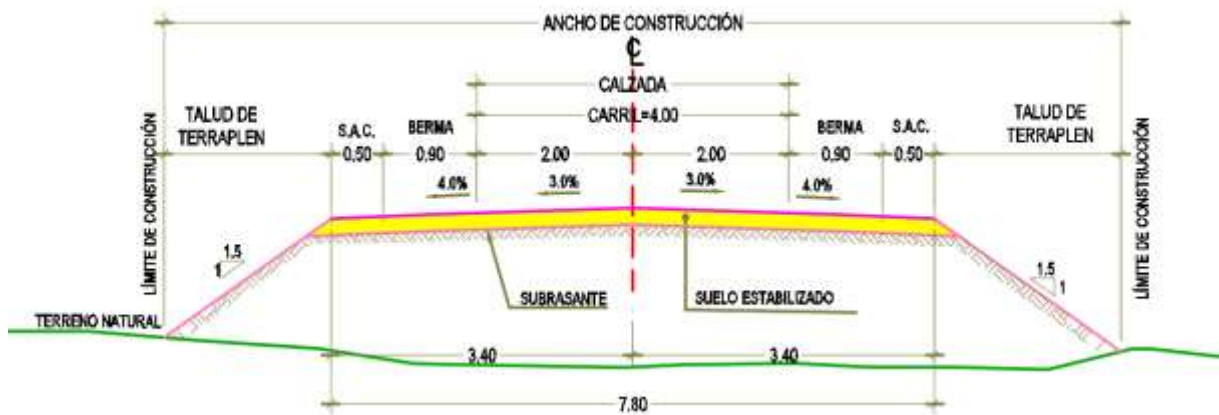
Sección típica en relleno. Fuente: Planos Secciones Típicas
